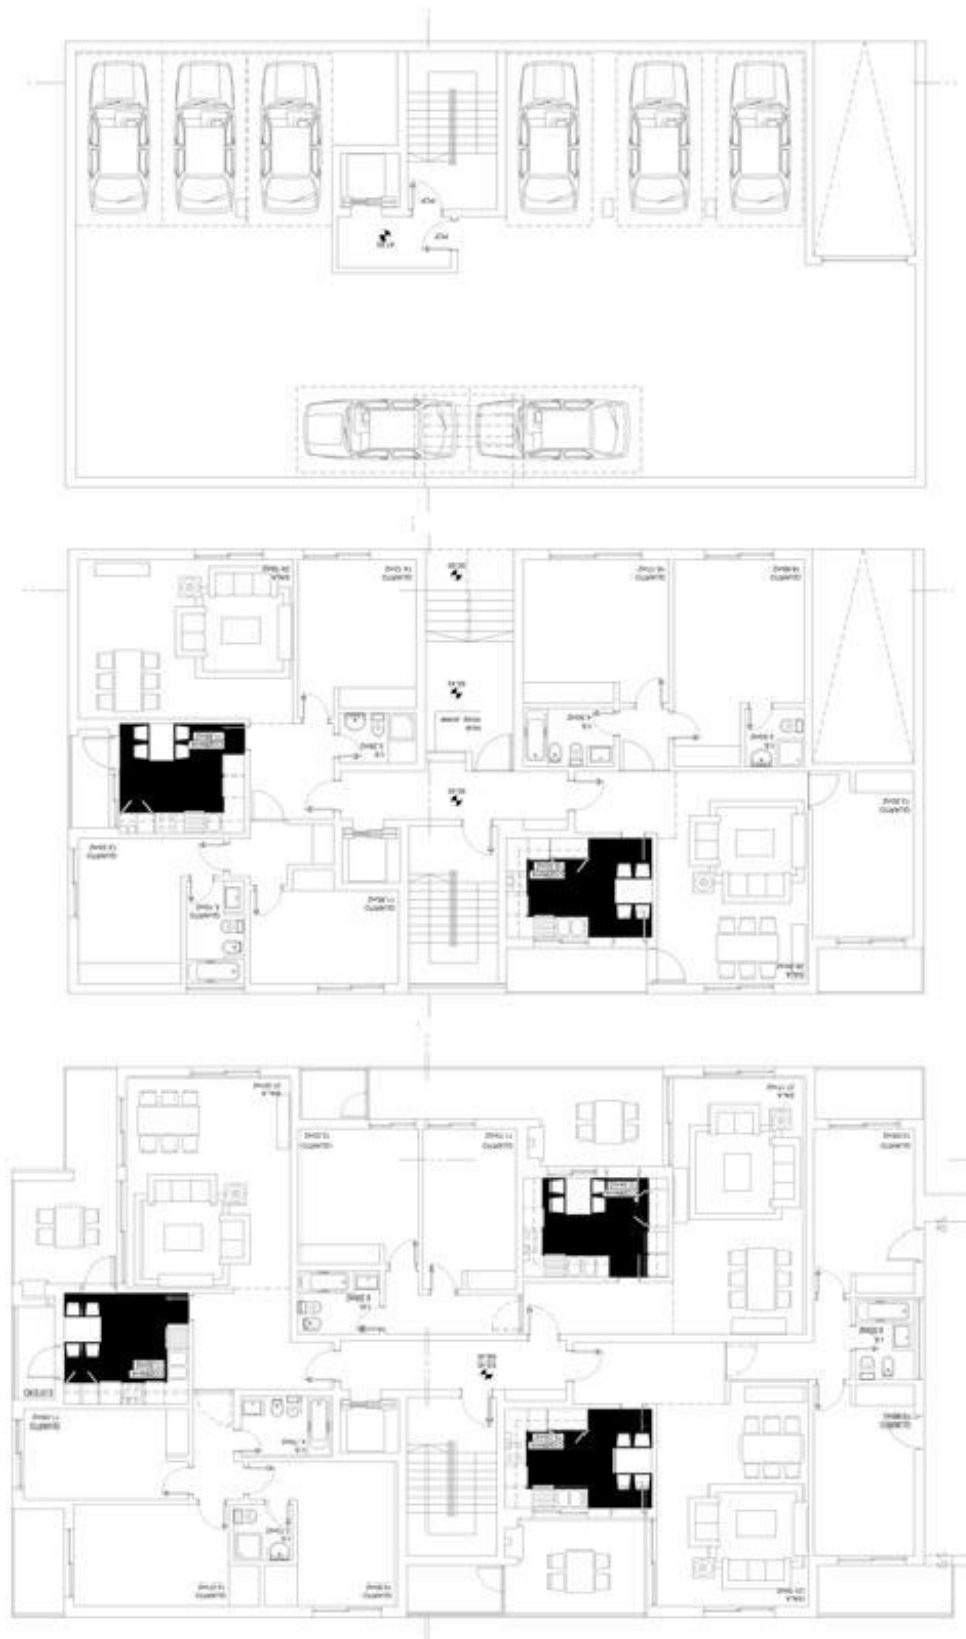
Plantas de arquitectura: pisos -1; 0; 1 e 2
